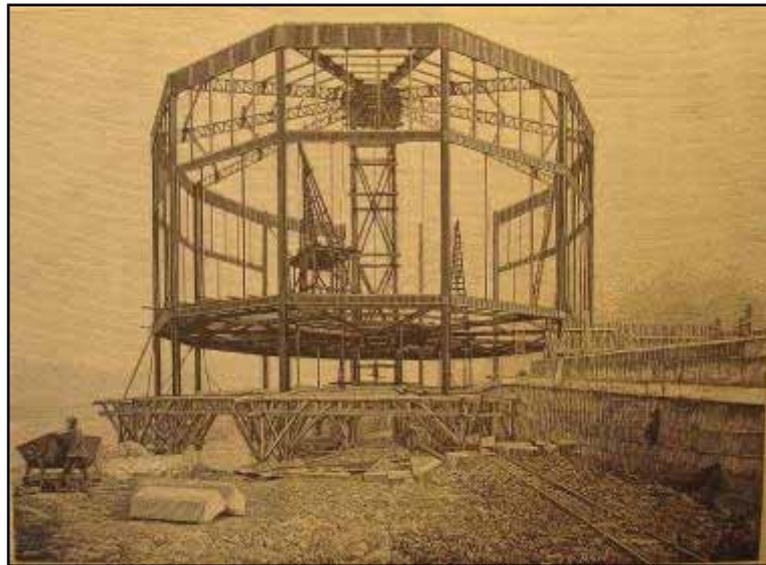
Etapa construtiva de uma rotunda com estrutura de ferro.
